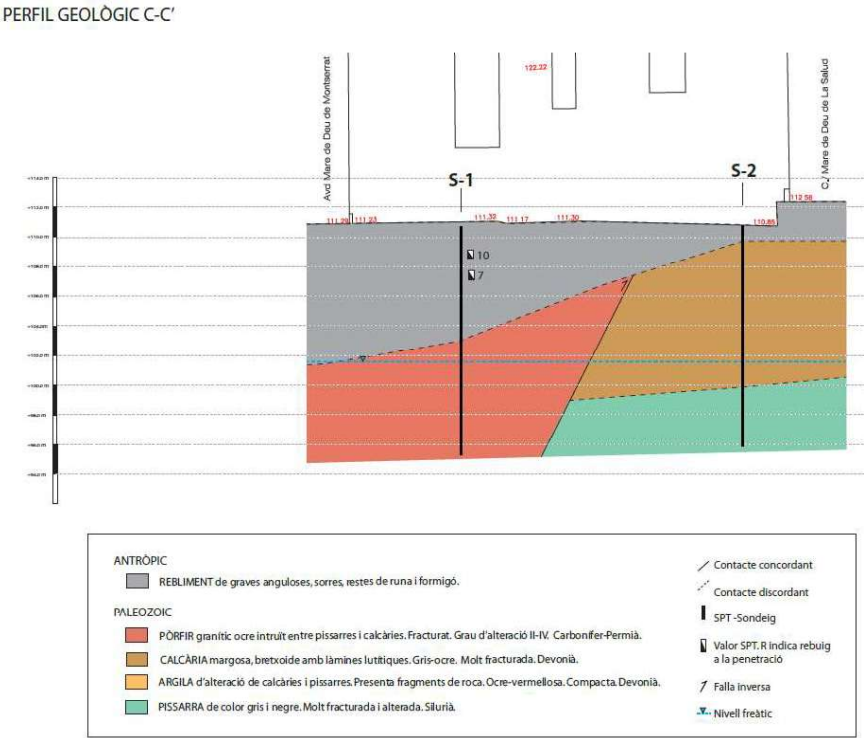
Perfil geotécnico C-C' (Fuente: Informe Geotécnico nº2123P6321)
